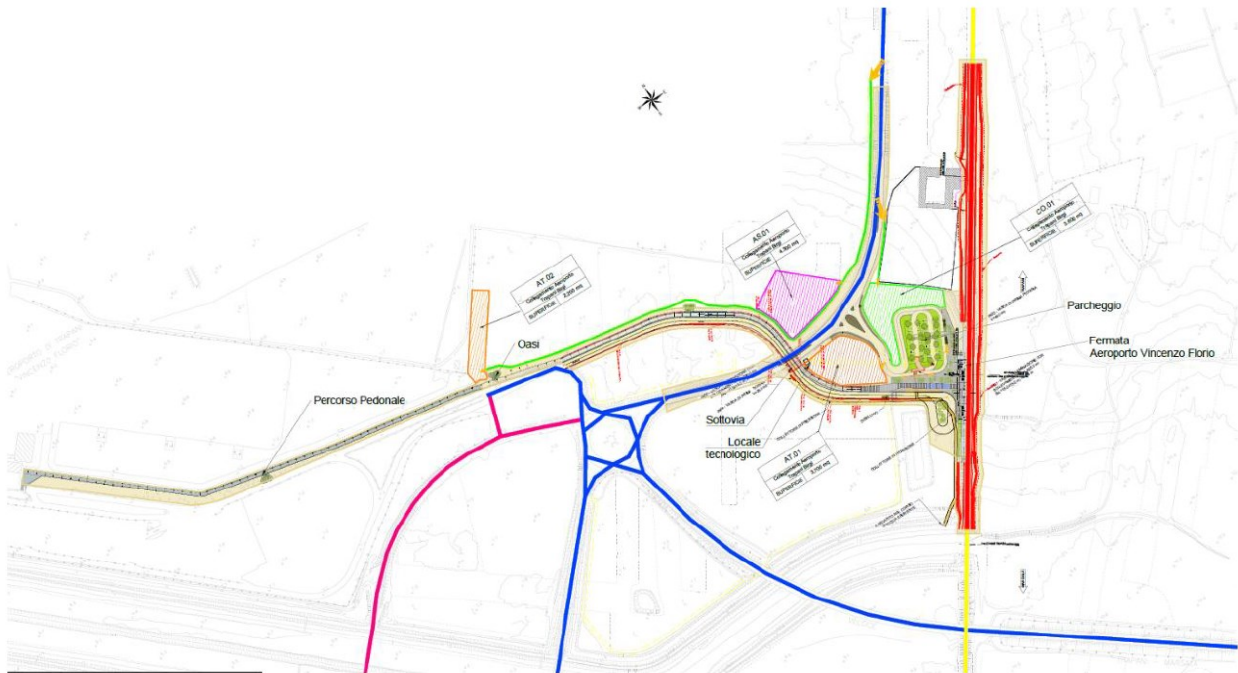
Planimetria di progetto. Fonte " Aspetti ambientali della cantierizzazione " allegato alla Lista di controllo.
